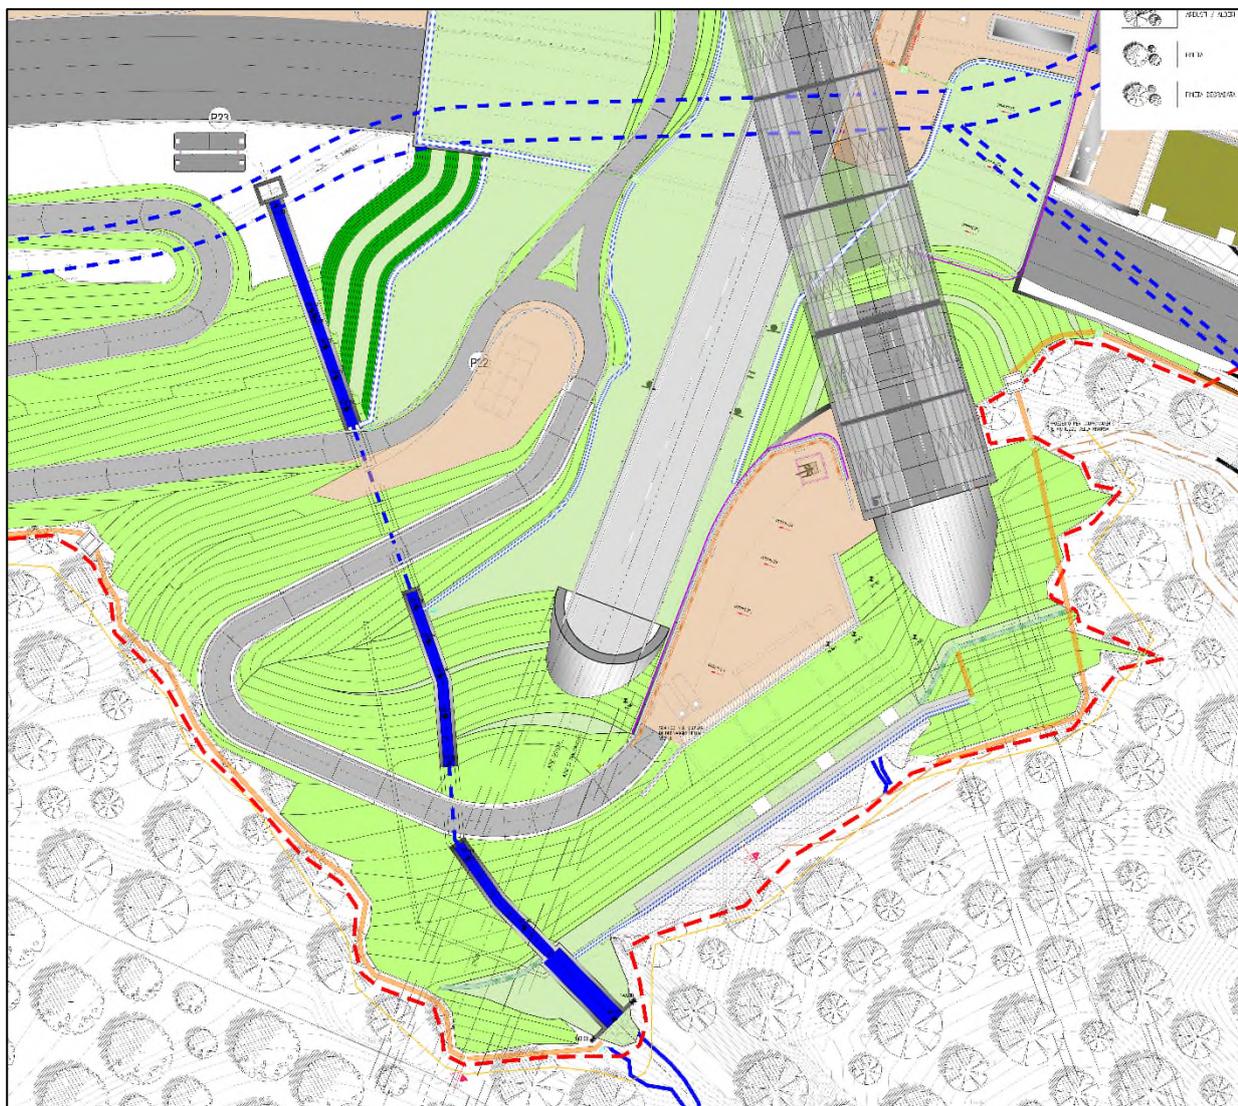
Planimetria finale dell'area d'imbocco (fonte: elaborato 110722-LL03-PE-A3-G16-GF16N-SSF00-D-AUA3714-2)
